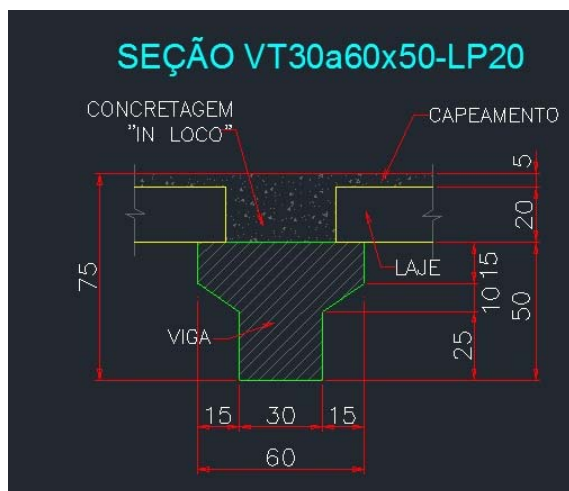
Seção da viga VF252 – Projeto estrutura pré-moldada
